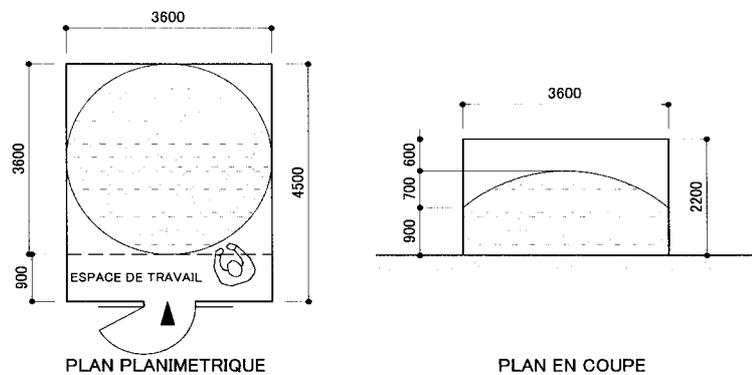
plan en coupe/plan planimétrique de la chambre de stockage de glace
